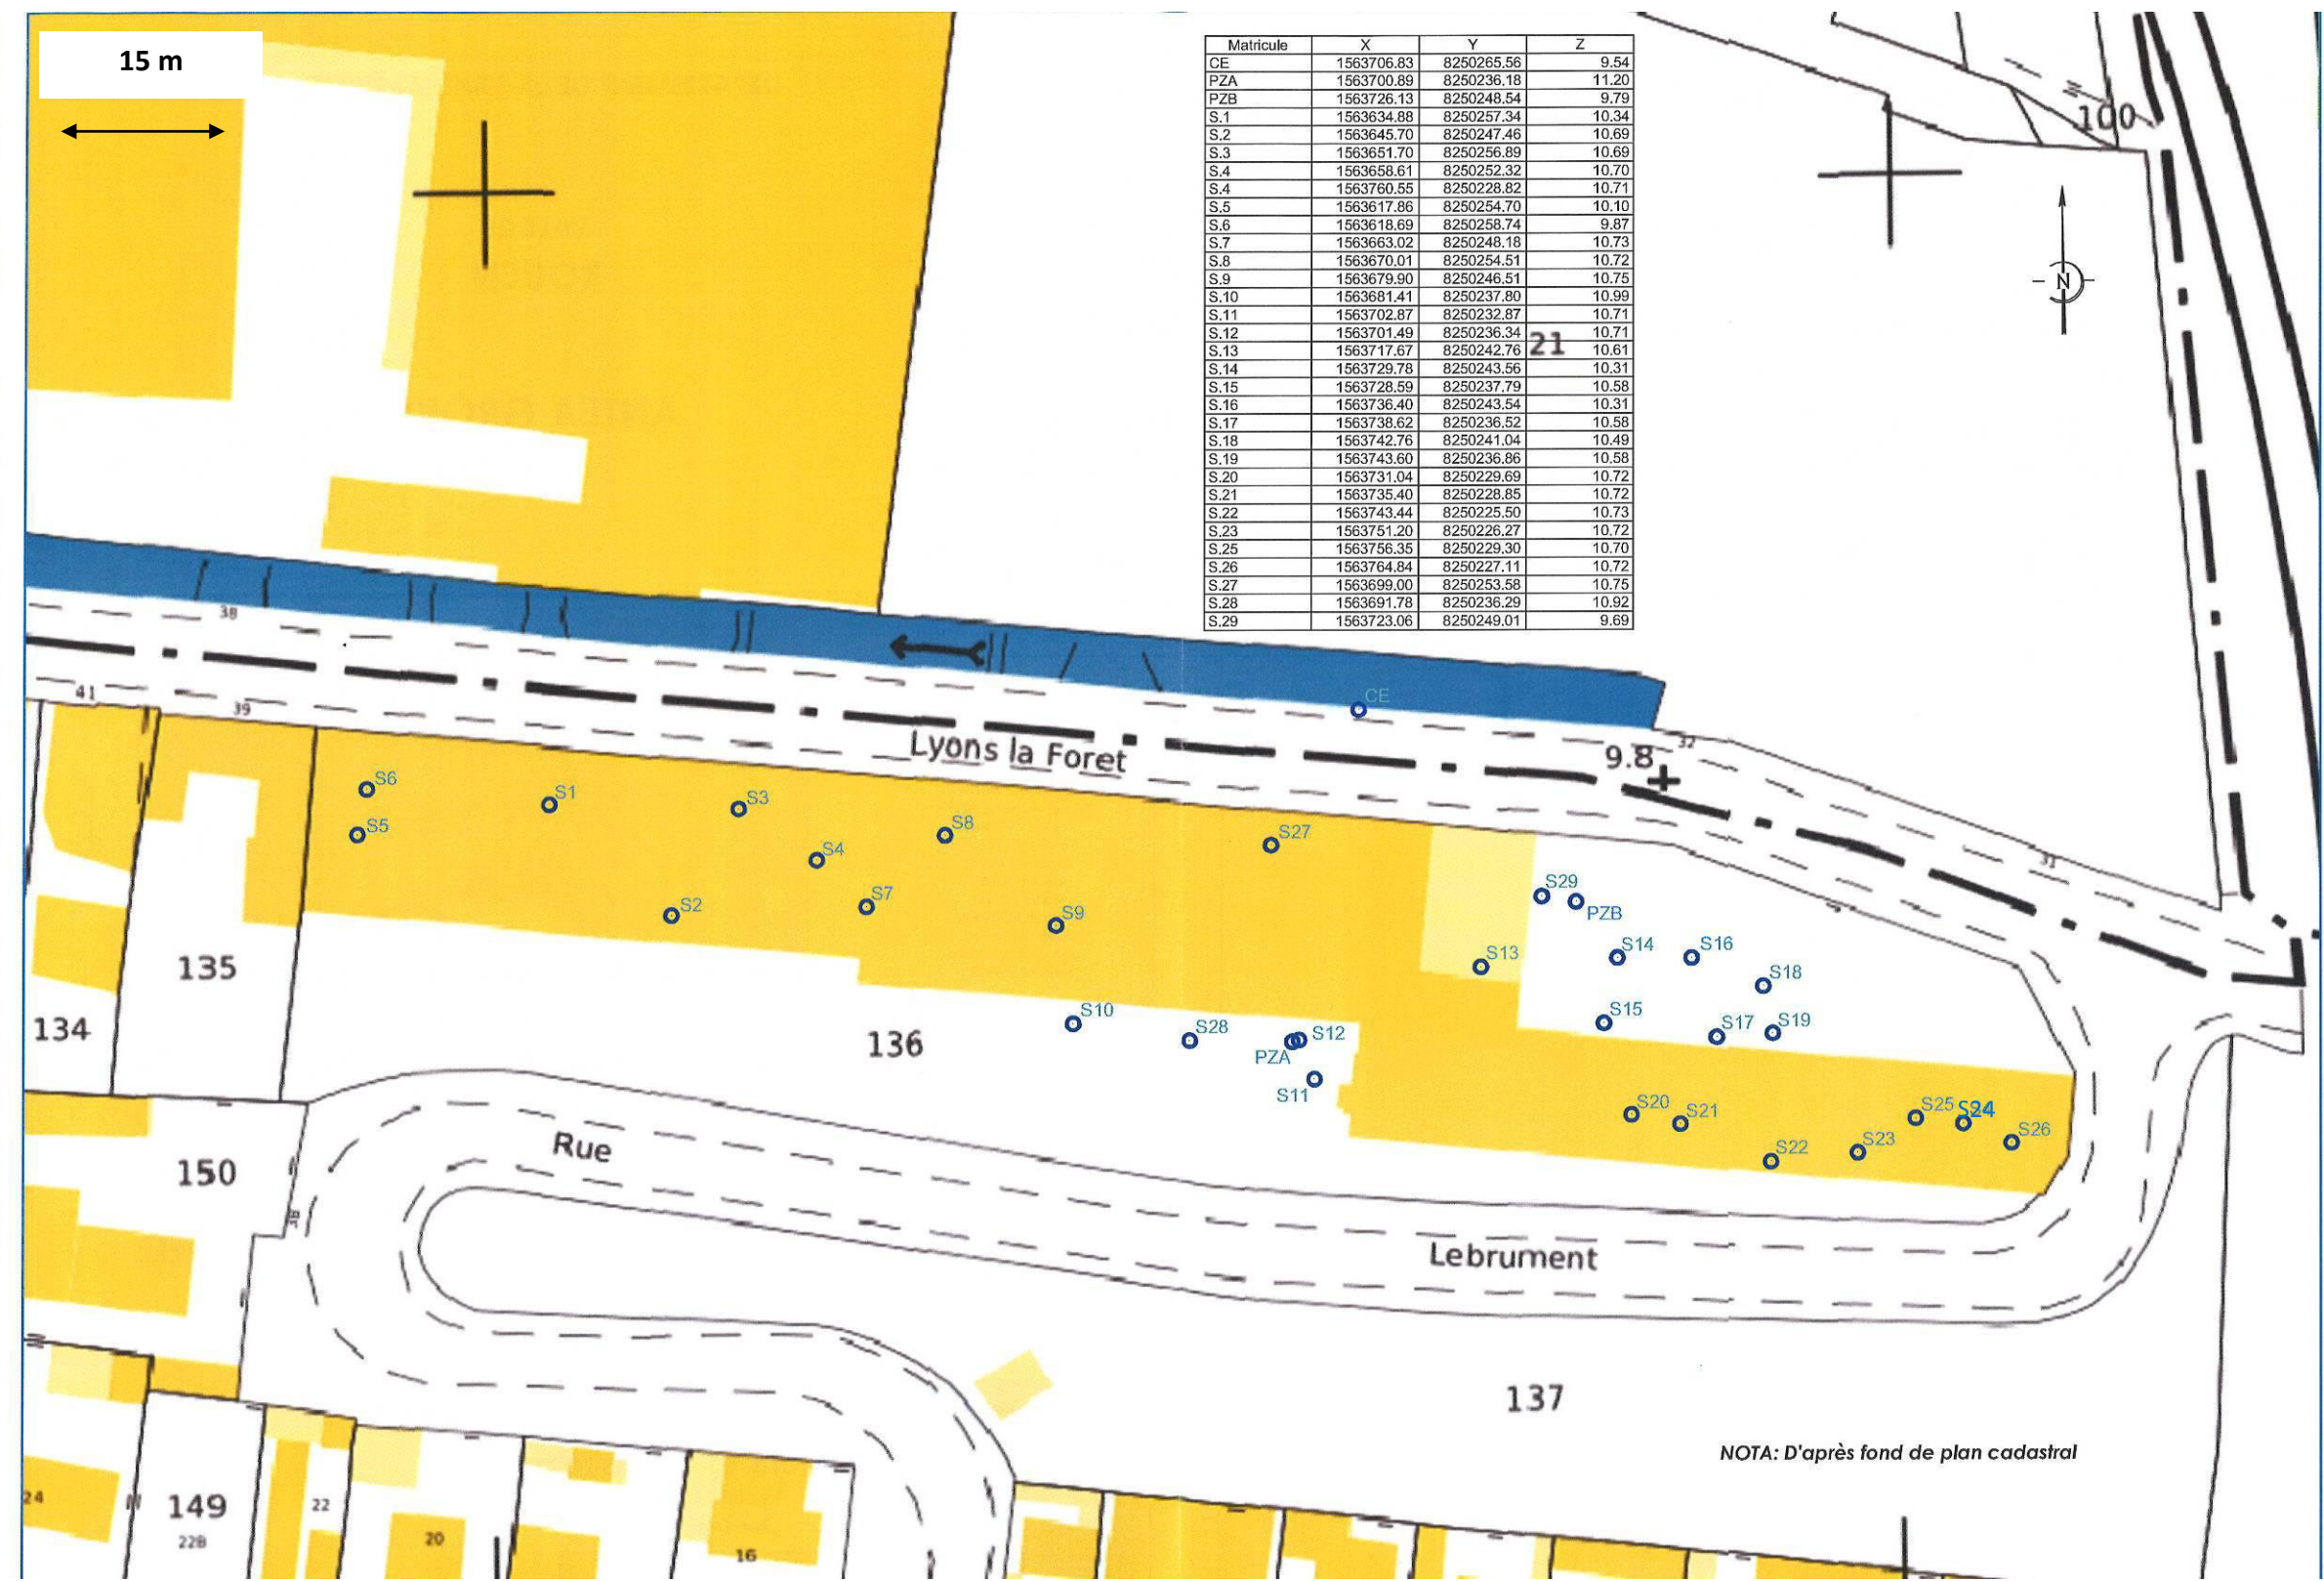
Plan de localisation des sondages de reconnaissance et piézomètres
